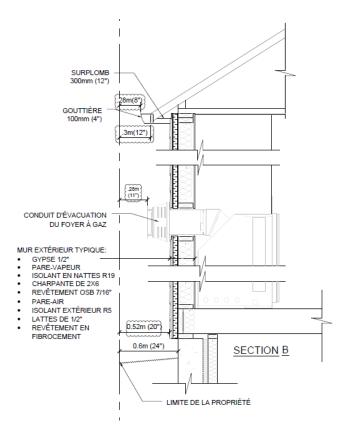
Coupe partielle du mur à un retrait de 0,6 m indiqué sur le plan d'implantation.
